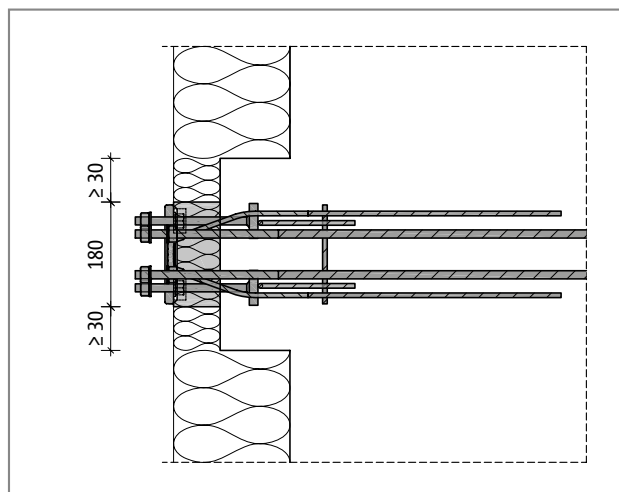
Schöck Isokorb® T tipo SKP: distanze tra i bordi
